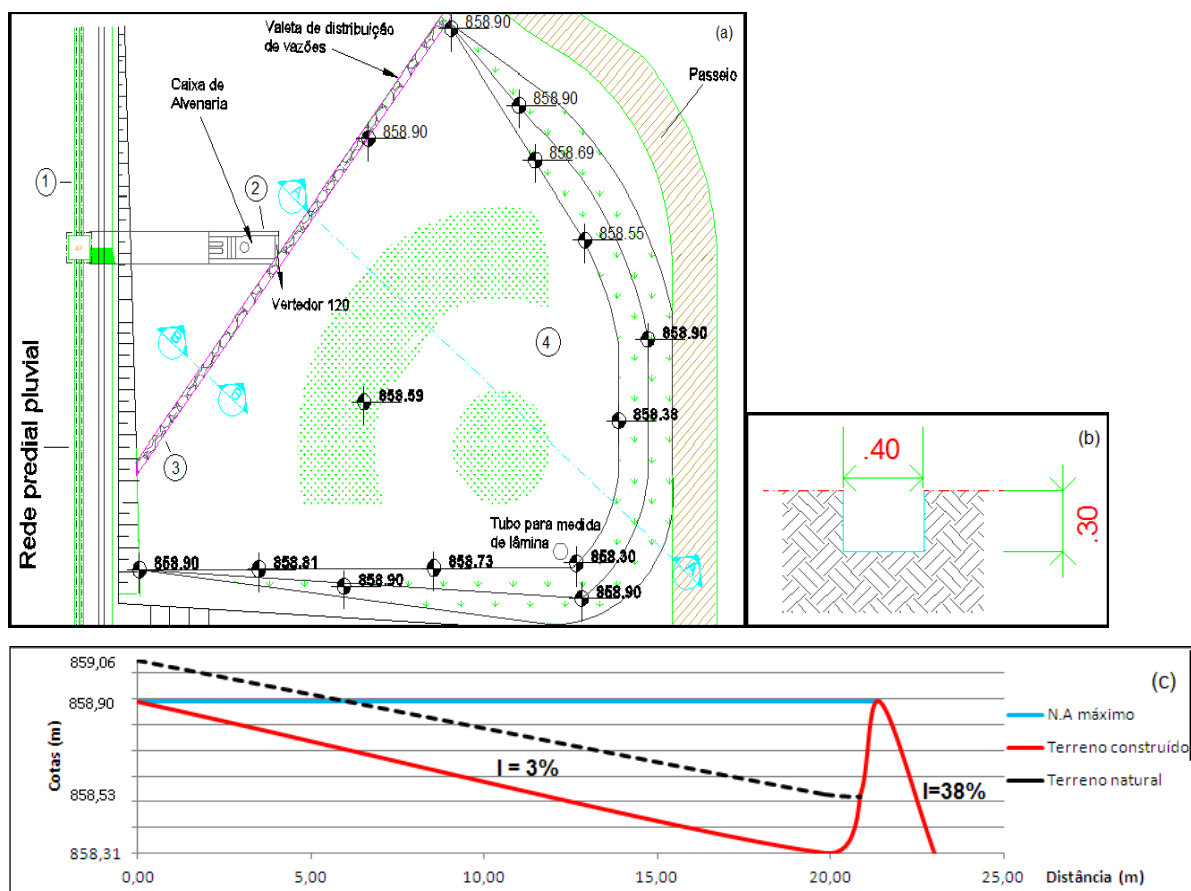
Plano de Infiltração em planta (a), corte BB do canal em brita (b) e o corte AA do plano de infiltração (c)
